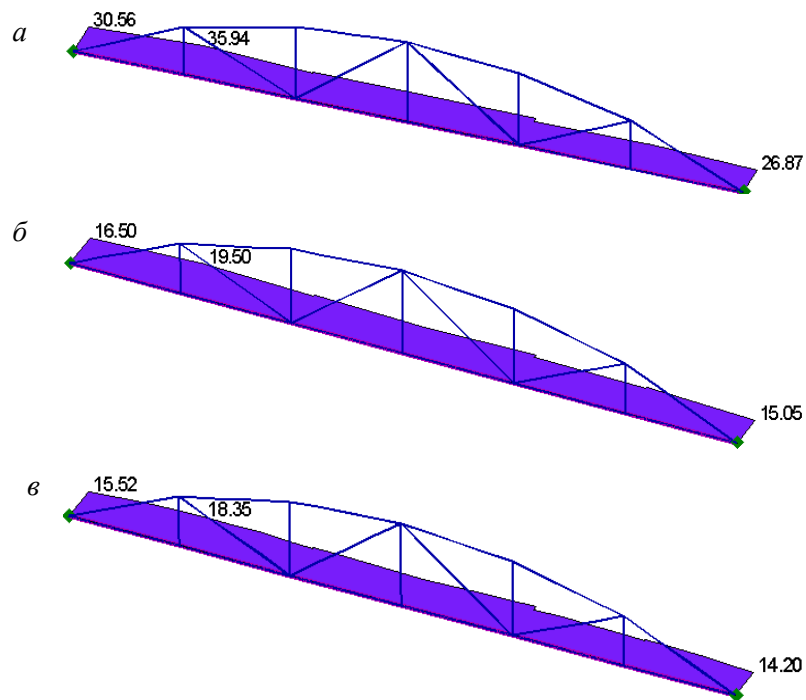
Эпюры необходимого расчетного продольного армирования (cm^2) в нижнем поясе рядовой стропильной фермы:
